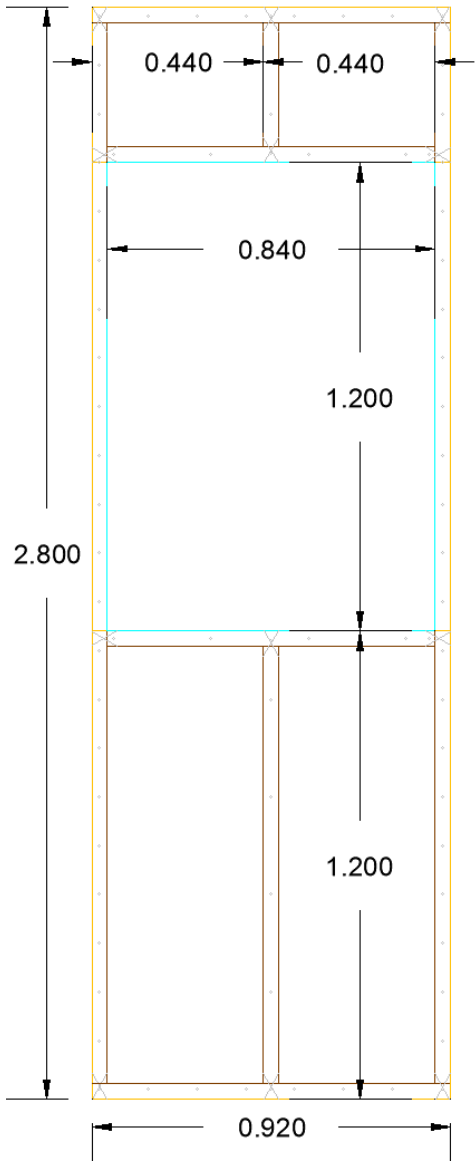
, Muro no estructural M6 0.92 x 2.8
